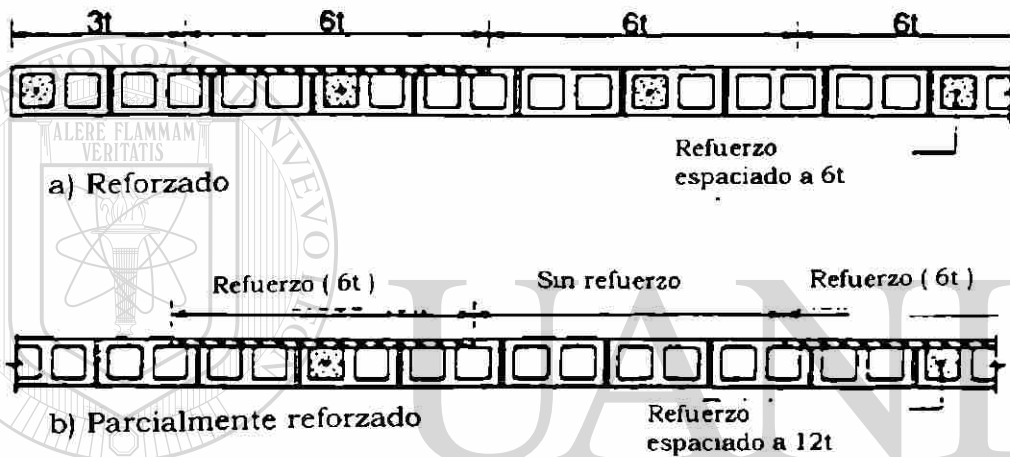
Tipos de reforzamiento de muros de mampostería.
